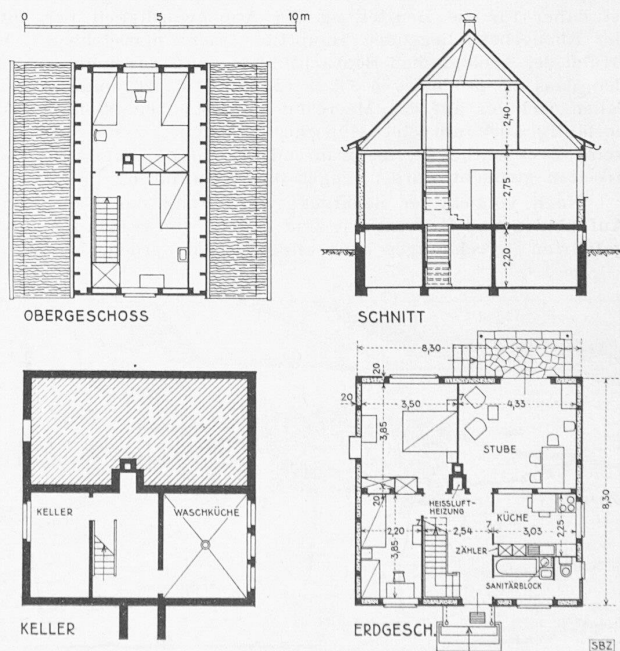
Grundrisse und Schnitt eines Einfamilienhauses, 1 : 250
